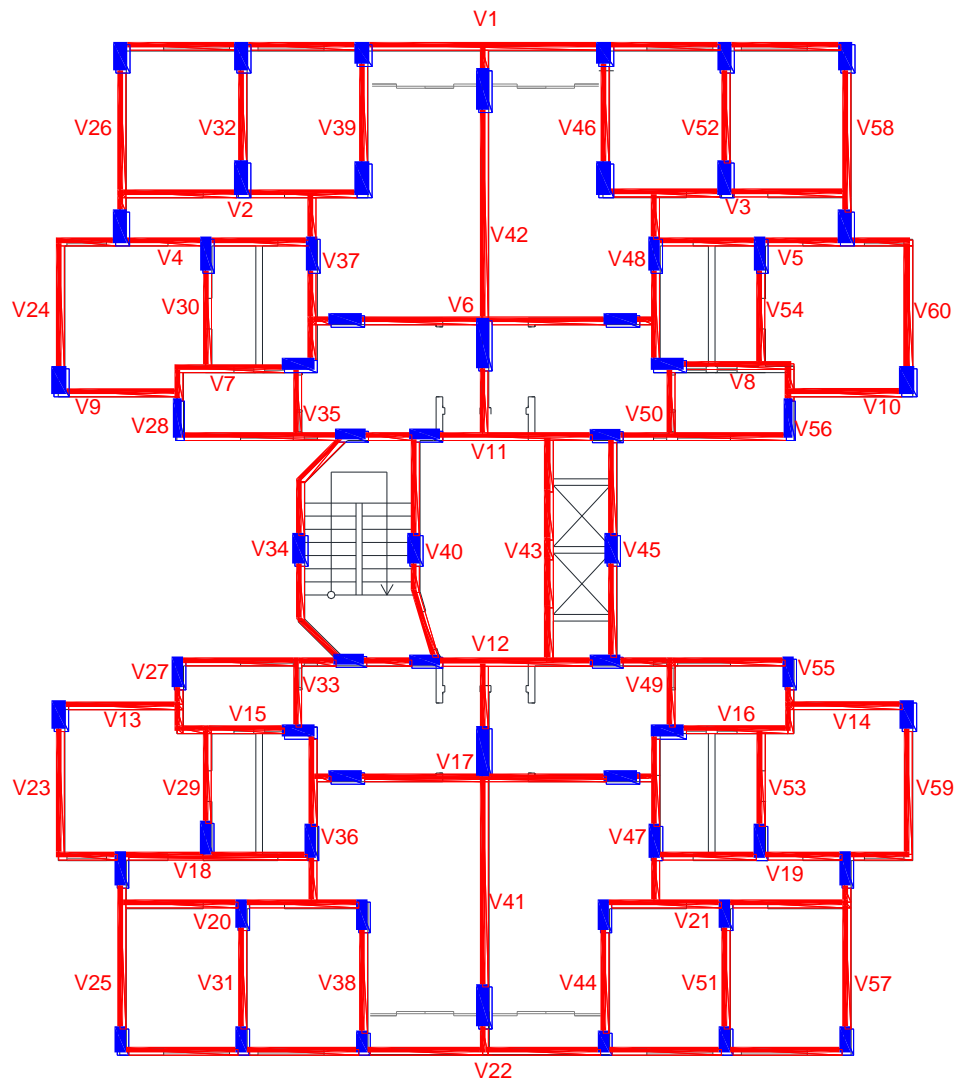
Localização dos pilares e das vigas em concreto armado – Residencial Bôscoli.
